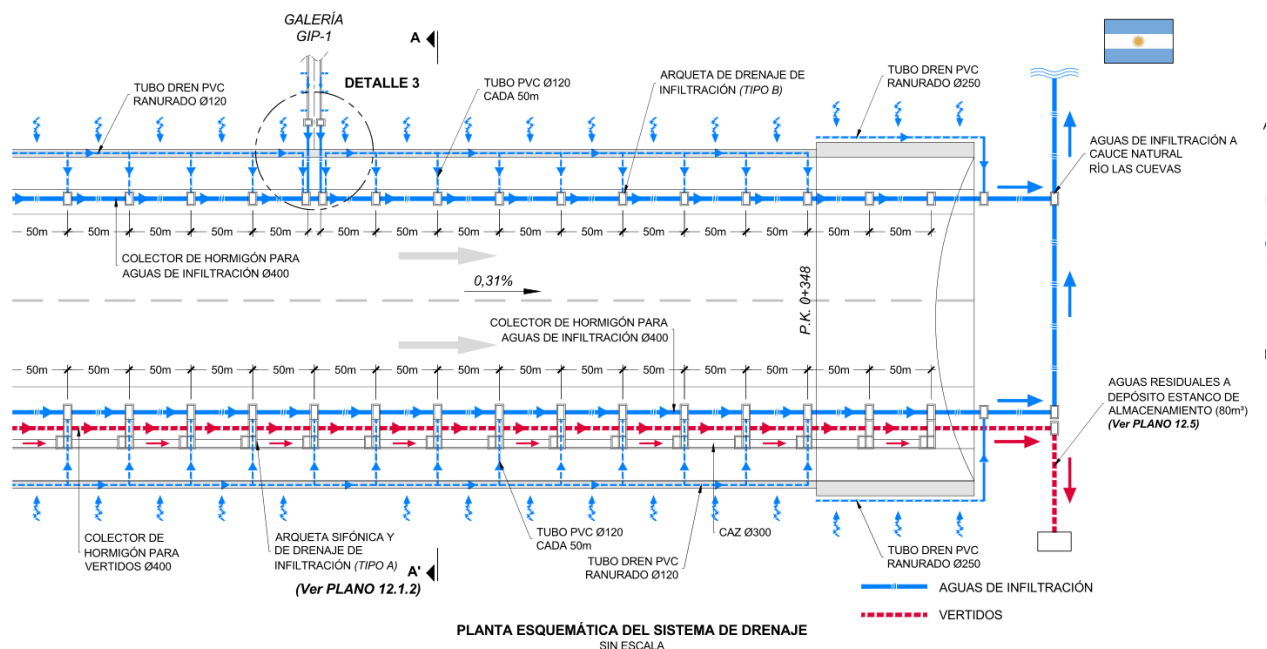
a. Esquema en planta de la red separativa de drenaje.
